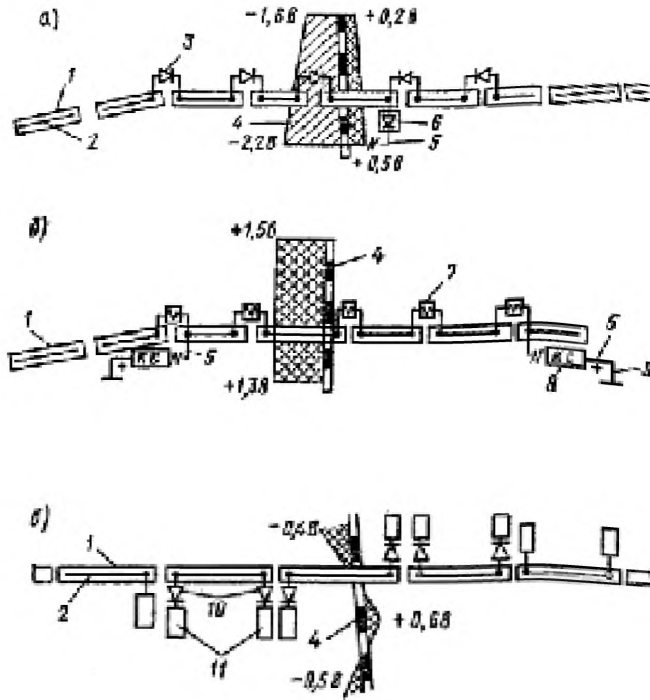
Схемы защиты блочной железобетонной конструкции
